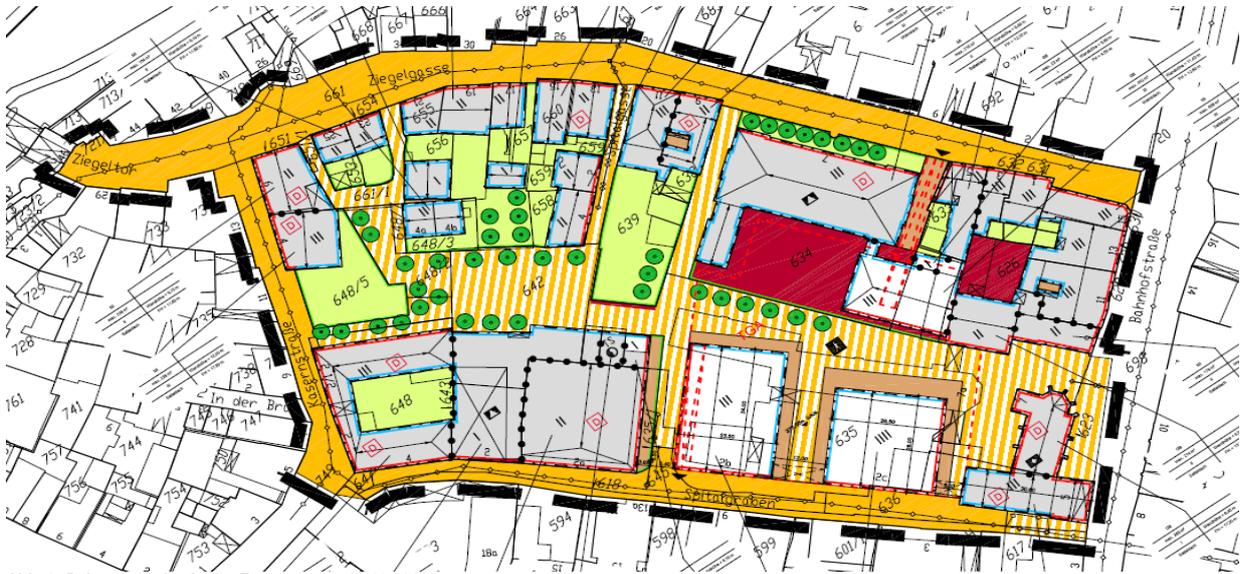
Bebauungsplan in der Fassung vom 08.10.2014
